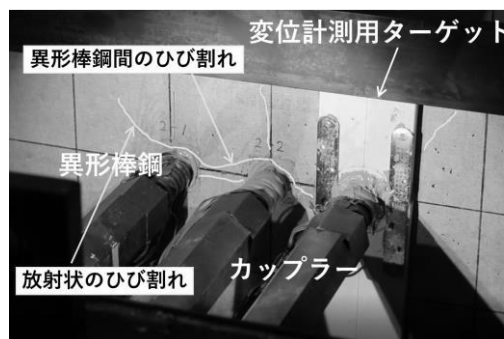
Case-2 異形棒鋼間のひび割れと 異形棒鋼を中心とした放射状のひび割れ (載荷終了時点)
